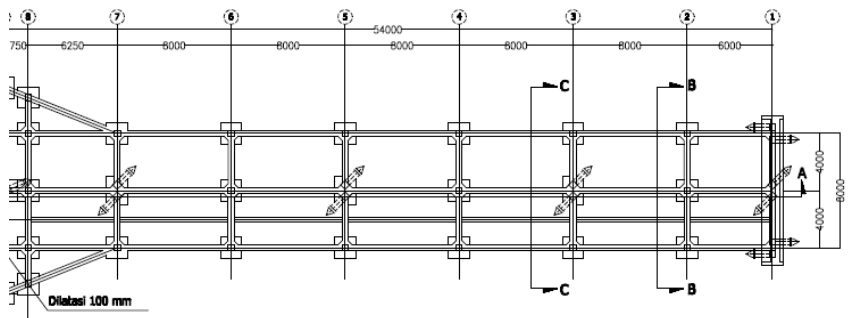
Rencana Modifikasi Pelat Dermaga dengan perubahan jarak pelat menjadi 7.2 m, sehingga pelat menjadi one way slab
